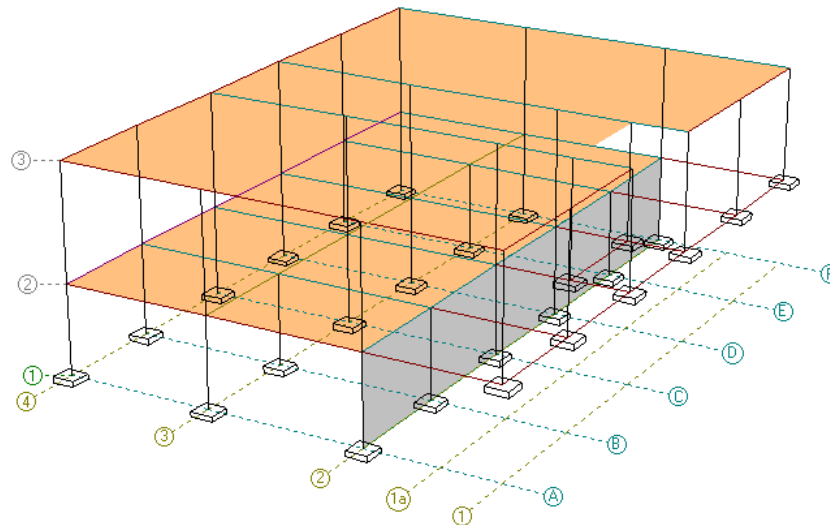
Vista 3D Modelo Estructural Edificio zona delantera entre ejes 4 y 1. Fuente: Propia
